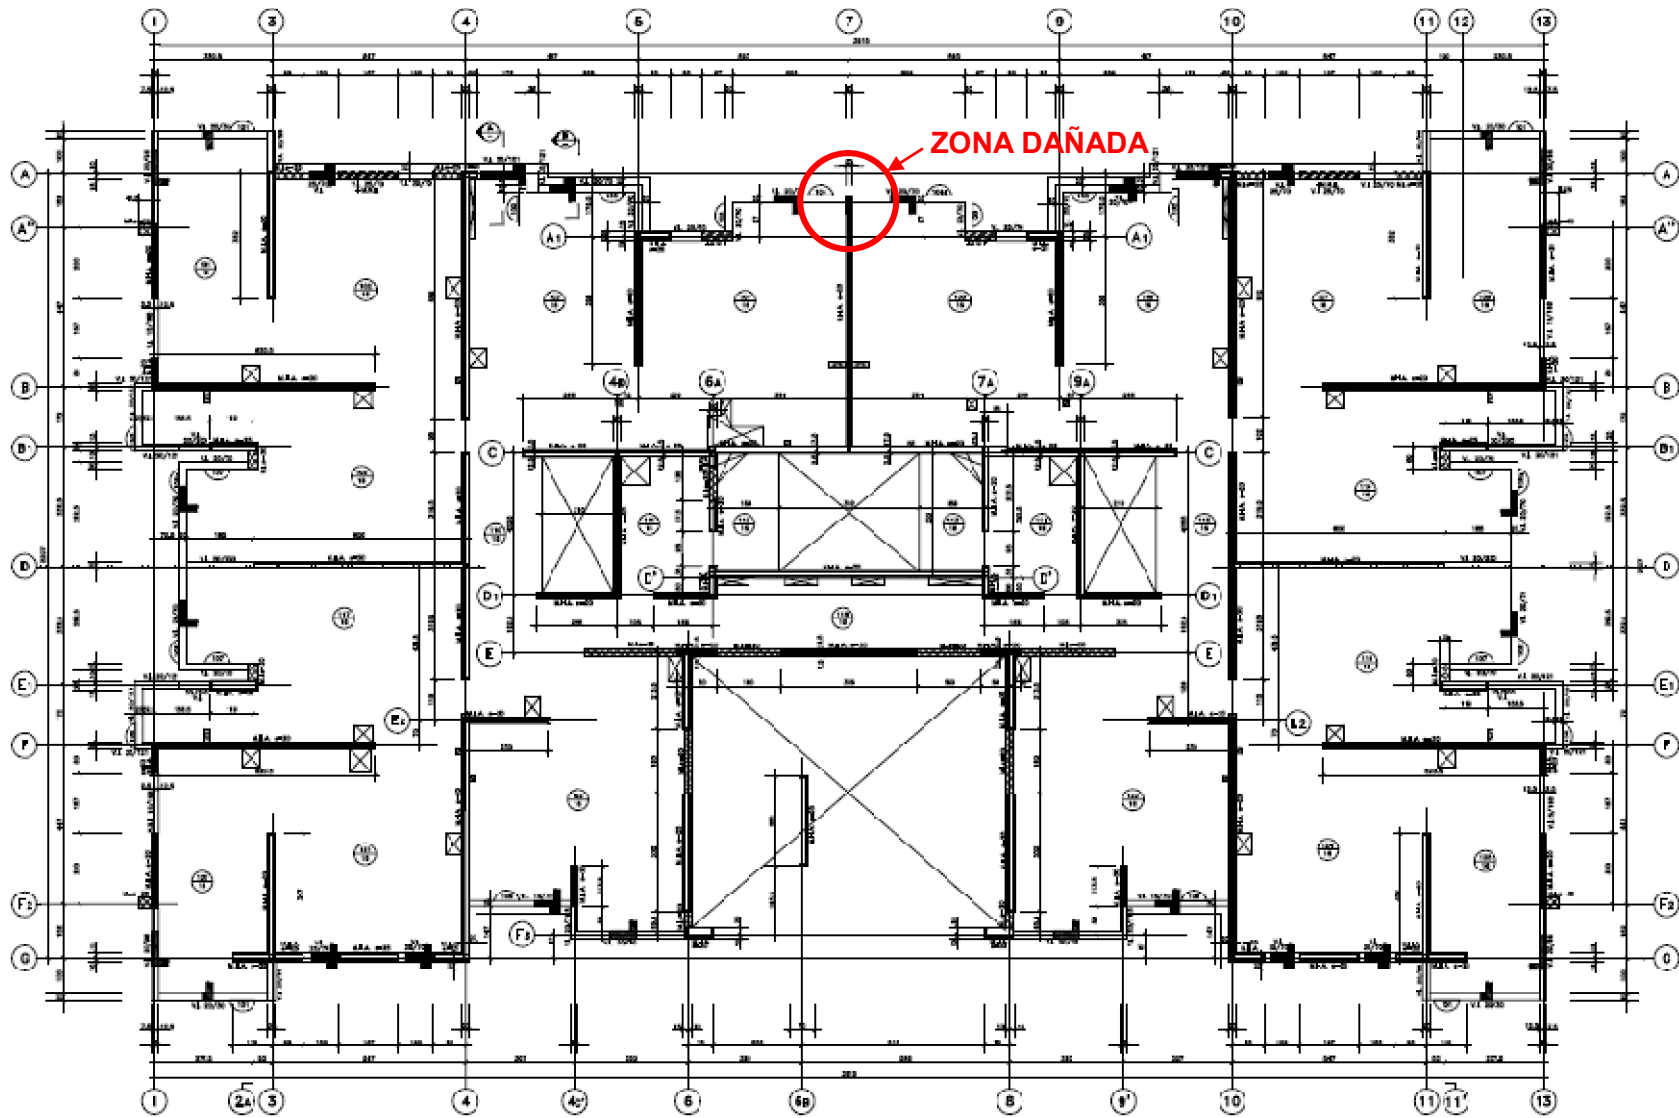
Zona Dañada - Planta cielo primer piso, Edificio A.
